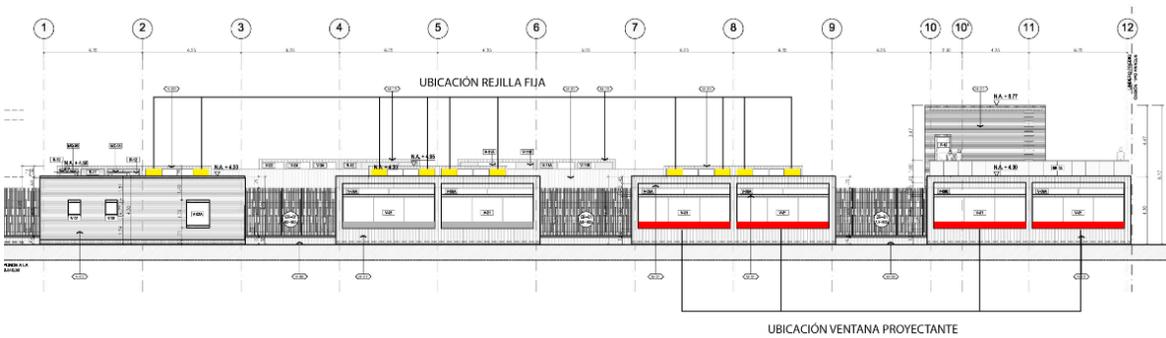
Localización aperturas en fachada oriente A-301 Anexos
